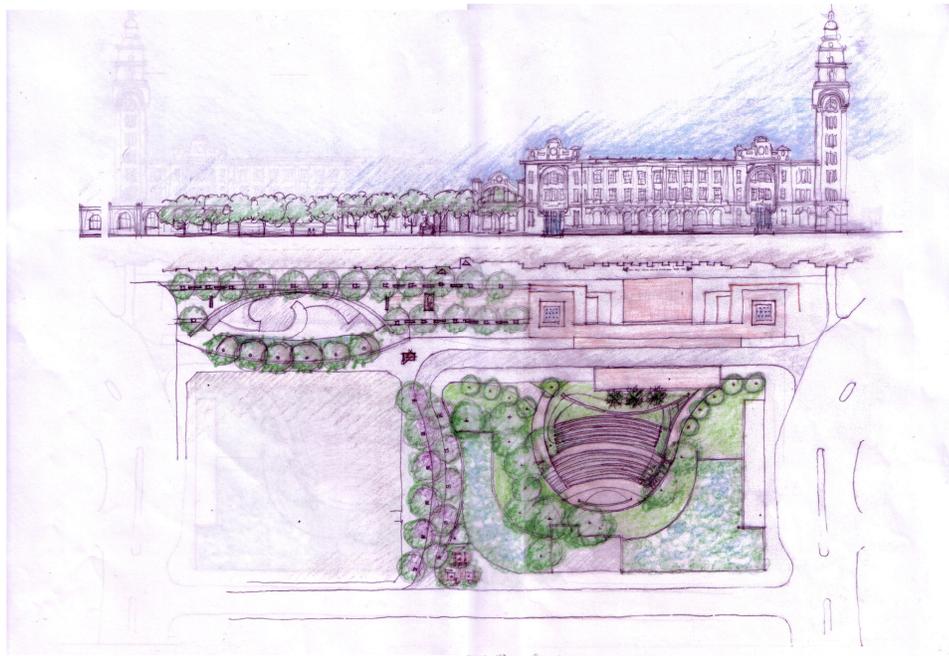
Croqui da concepção original para remodelação da Praça Júlio Prestes
